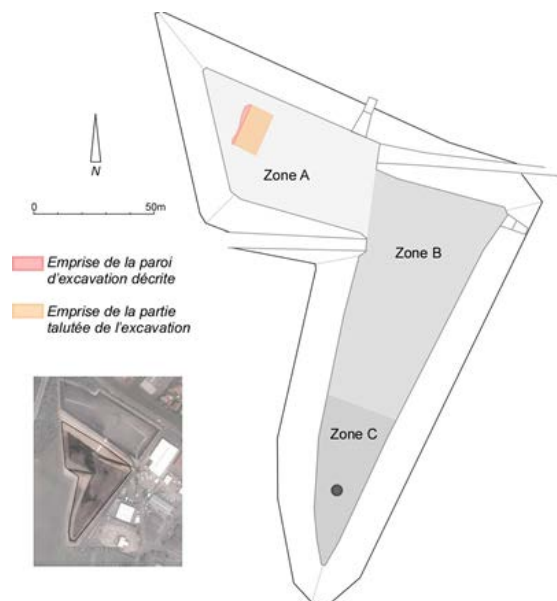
Excavation réalisée dans les zones A du bassin DjR (Goutaland, 2008)
